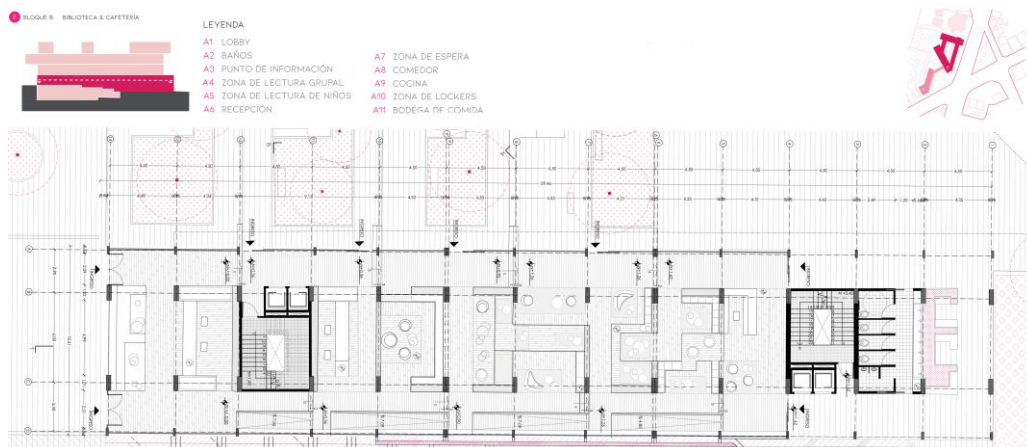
Planta Baja – Bloque B1. Fuente: (Andrade, 2019).
